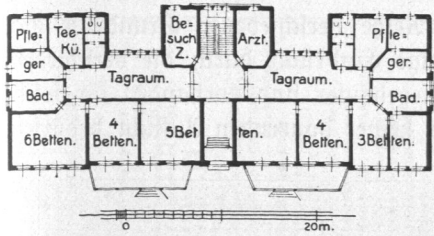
Irrenanstalt Friedrichsberg, Haus für unruhige Männer III. Klasse, Erdgesch. Grundriß.
